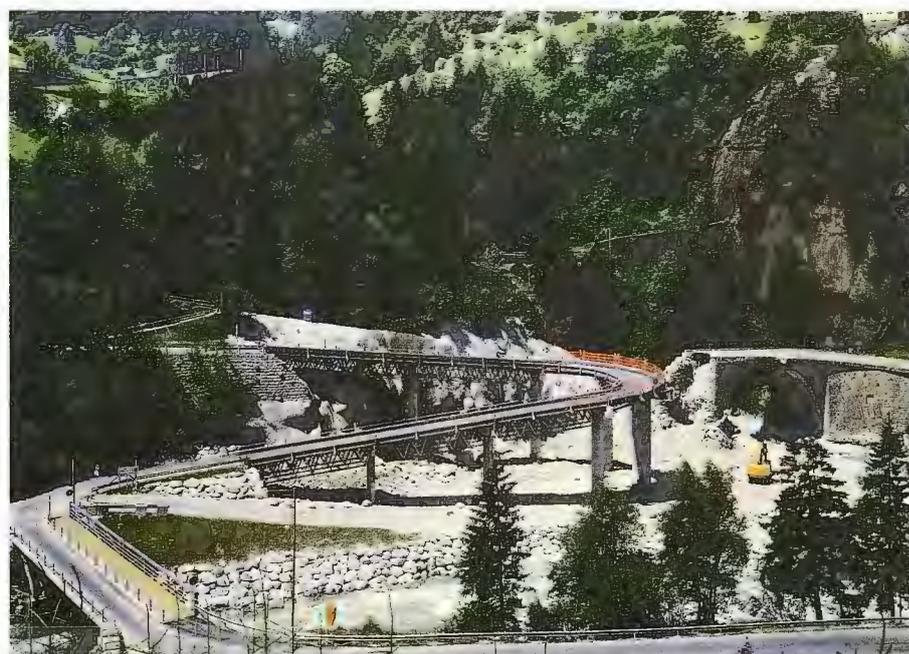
Provisorische Kantonsstrasse zwischen dem Pfaffensprung und Wassen (Foto Basler + Hofmann)
